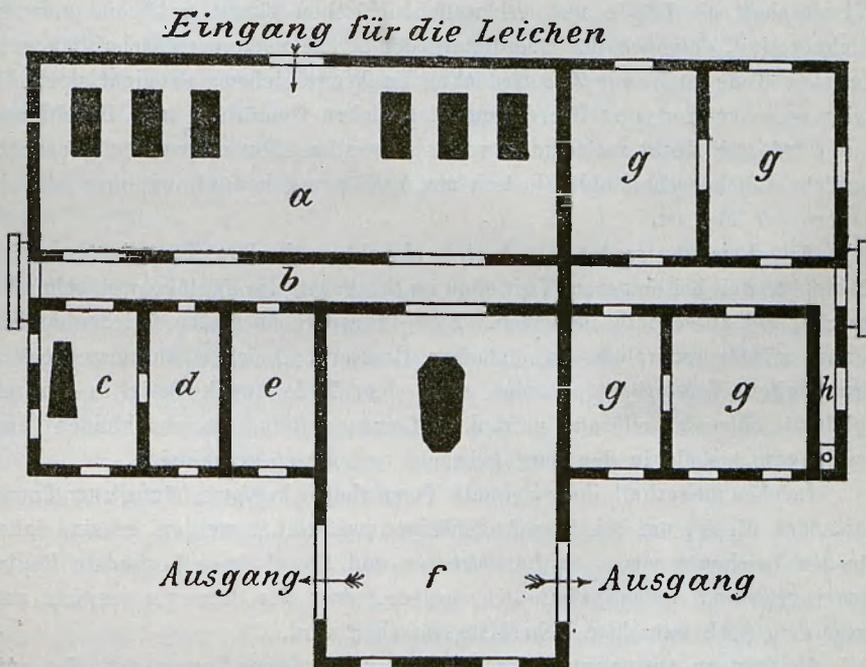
Grundriss einer Leichenhalle mit Einsegnungsraum.
